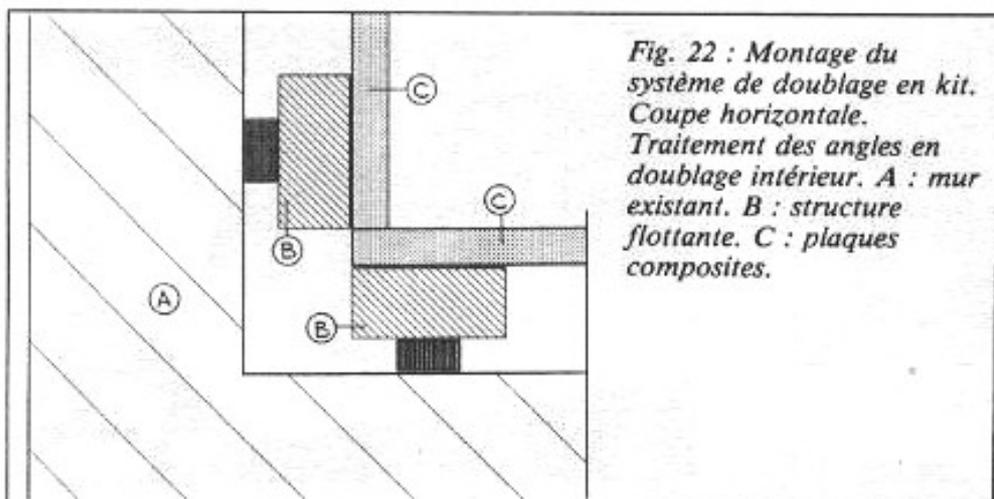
Montage du système de doublage en kit. Coupe horizontale. Traitement des angles en doublage intérieur. A : mur existant. B : structure flottante. C : plaques composites.
